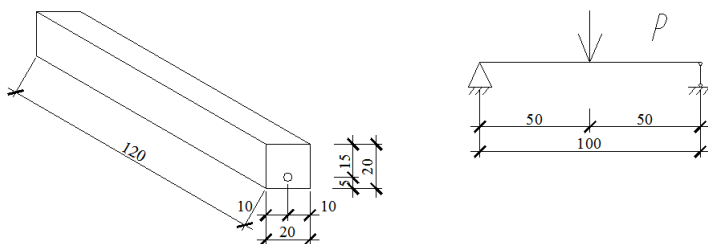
Габаритные размеры образца и схема приложения усилий
